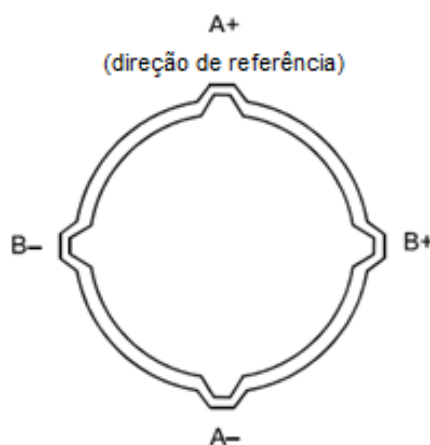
Seção transversal do tubo guia. Fonte: Geokon (2008)
